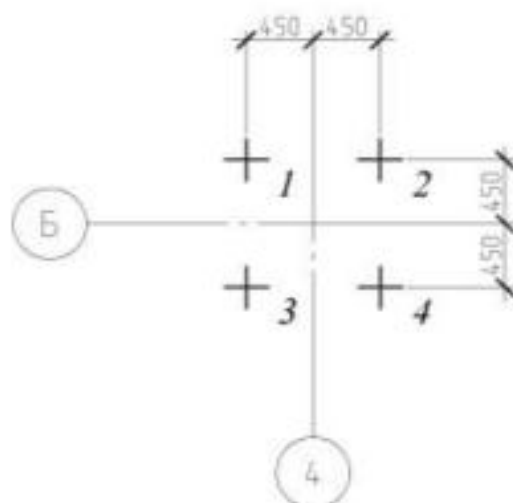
Пример оформления плана свай отдельного свайного фундамента
